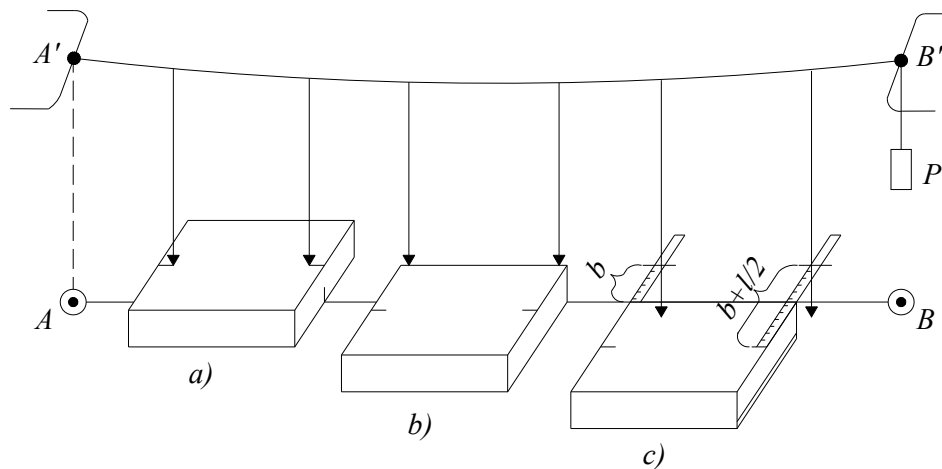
Схема монтажу фундаментних блоків з допомогою струнного способу з орієнтацією:
